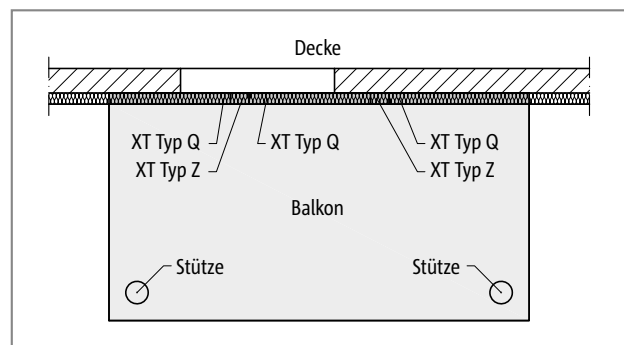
Schöck Isokorb® XT Typ Z, Q: Balkon mit Stützenlagerung
